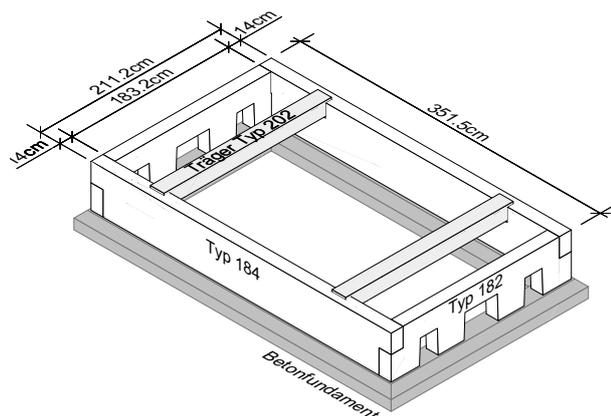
Unterbau und Fundament Typ RECHTECK 5, TYP 257
